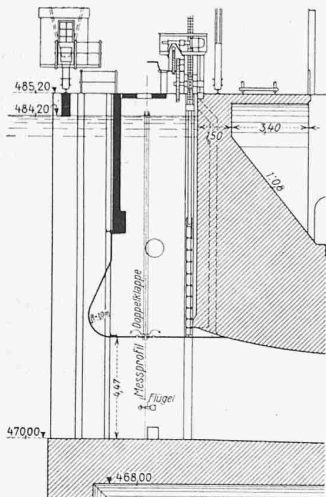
Holzeinbau für die Wassermessung im Einlauf. — 1 : 300.
